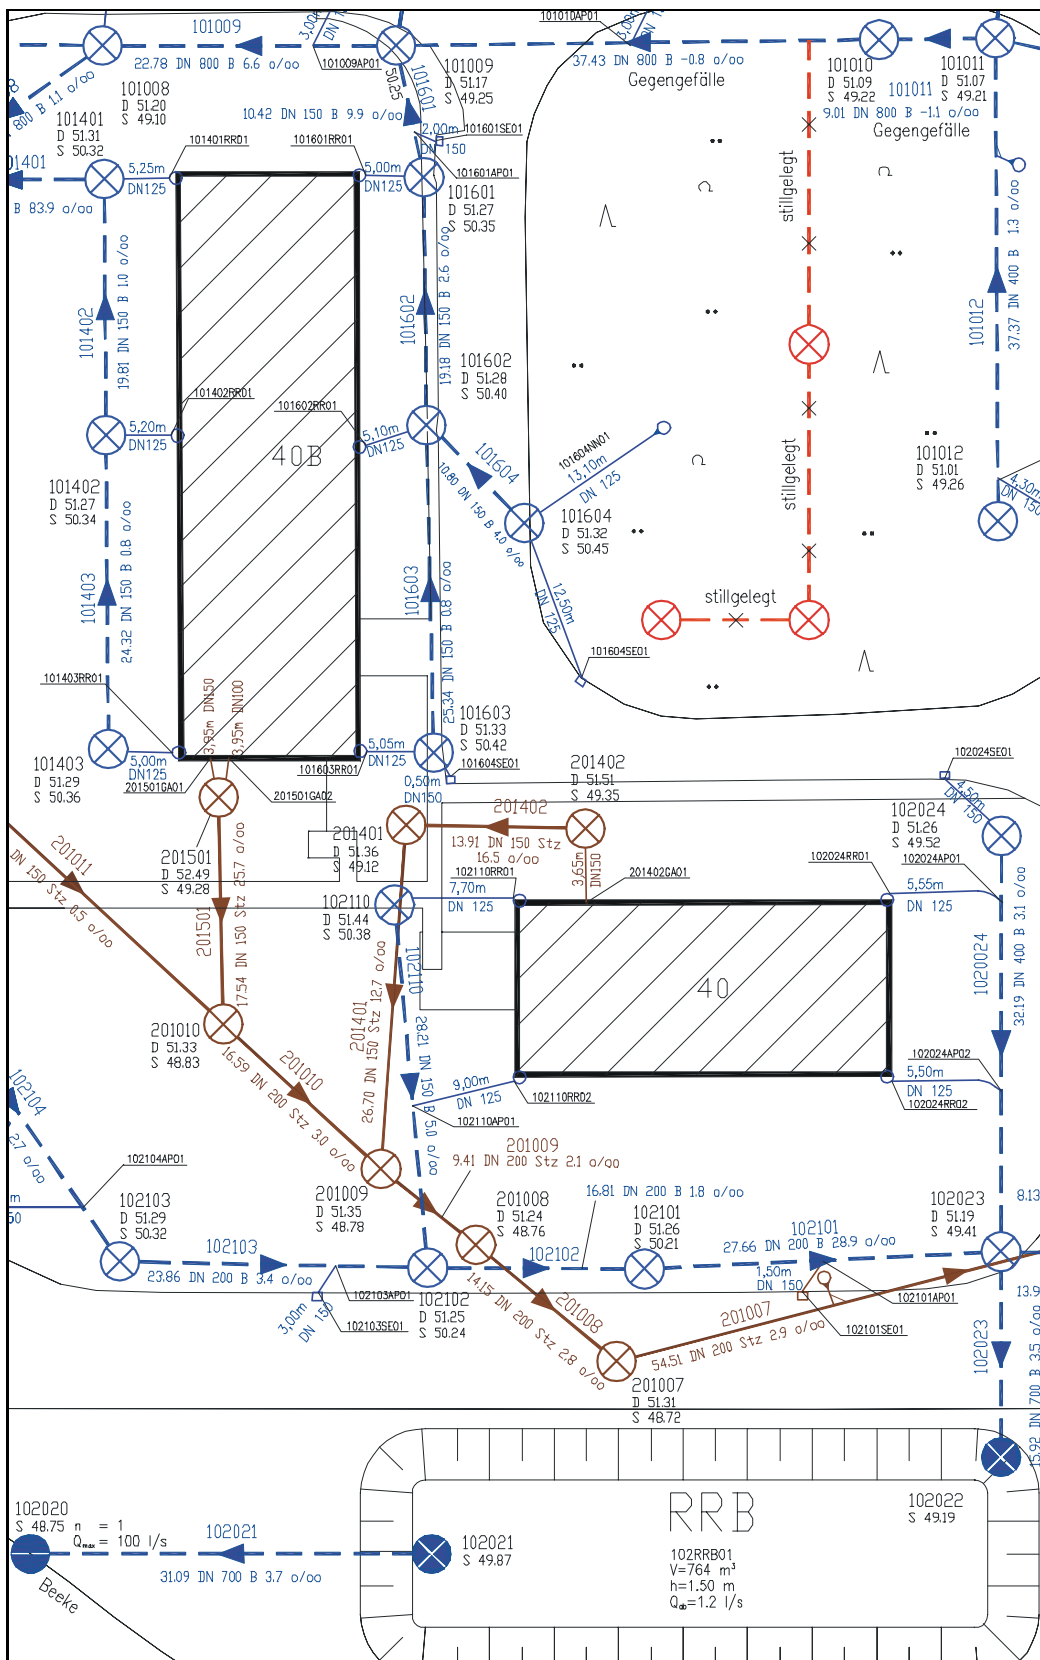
4 Beispielplan: Lageplan "Bestand Abwasser"
